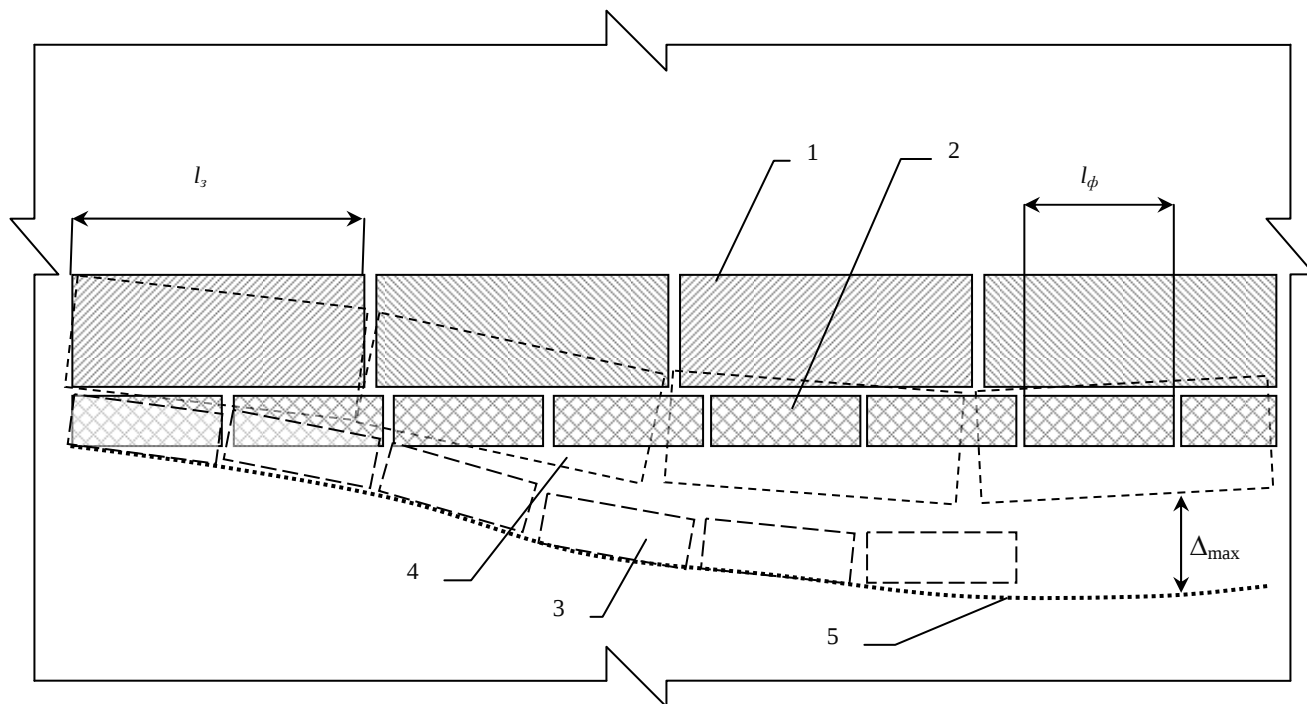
Розрахункова схема деформації водопропускної труби внаслідок переміщення (зрушення) основи: 1 – проектне положення ланки труби; 2 – проектне положення блоку фундаменту; 3 – положення блоку фундаменту після переміщення; 4 – положення ланки труби після переміщення; 5 – очікувана лінія опису переміщення основи; l_s – довжина ланки труби; l_ϕ – довжина блоку фундаменту; $\Delta_{\max}$ – максимальне значення вертикального переміщення на ділянці.
